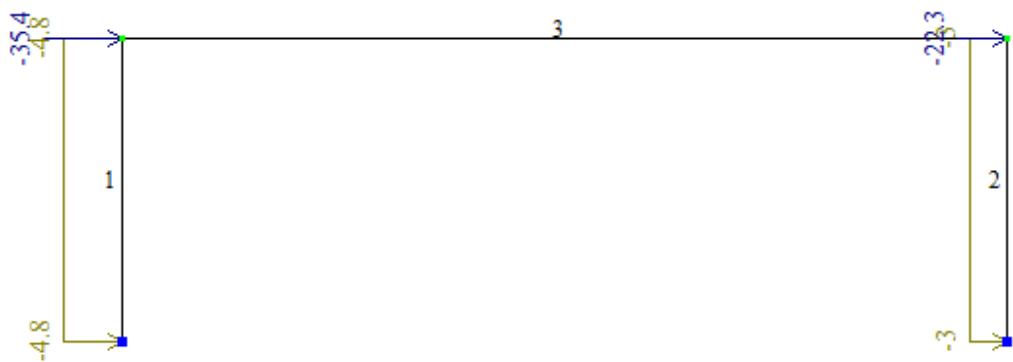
Розрахункова схема рами на дію вітрового навантаження
